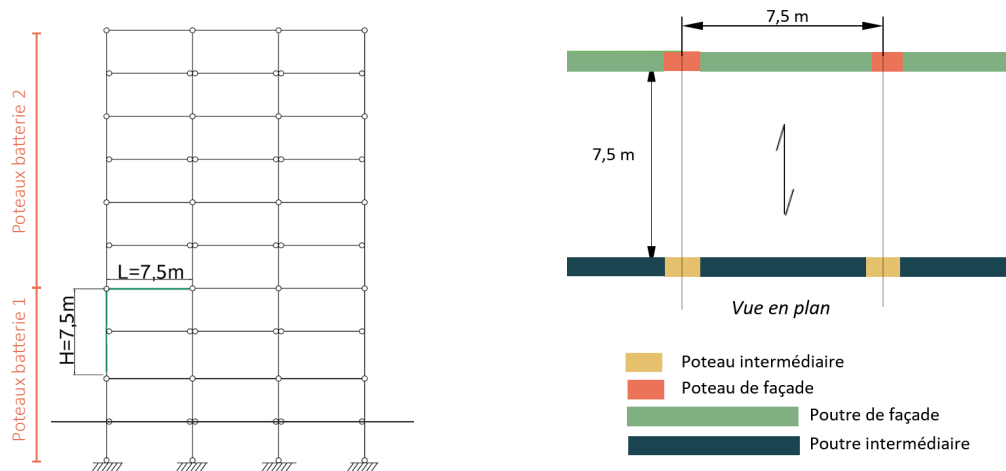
Schéma statique du bâtiment réemployable avec éléments poteaux et poutres réutilisables
